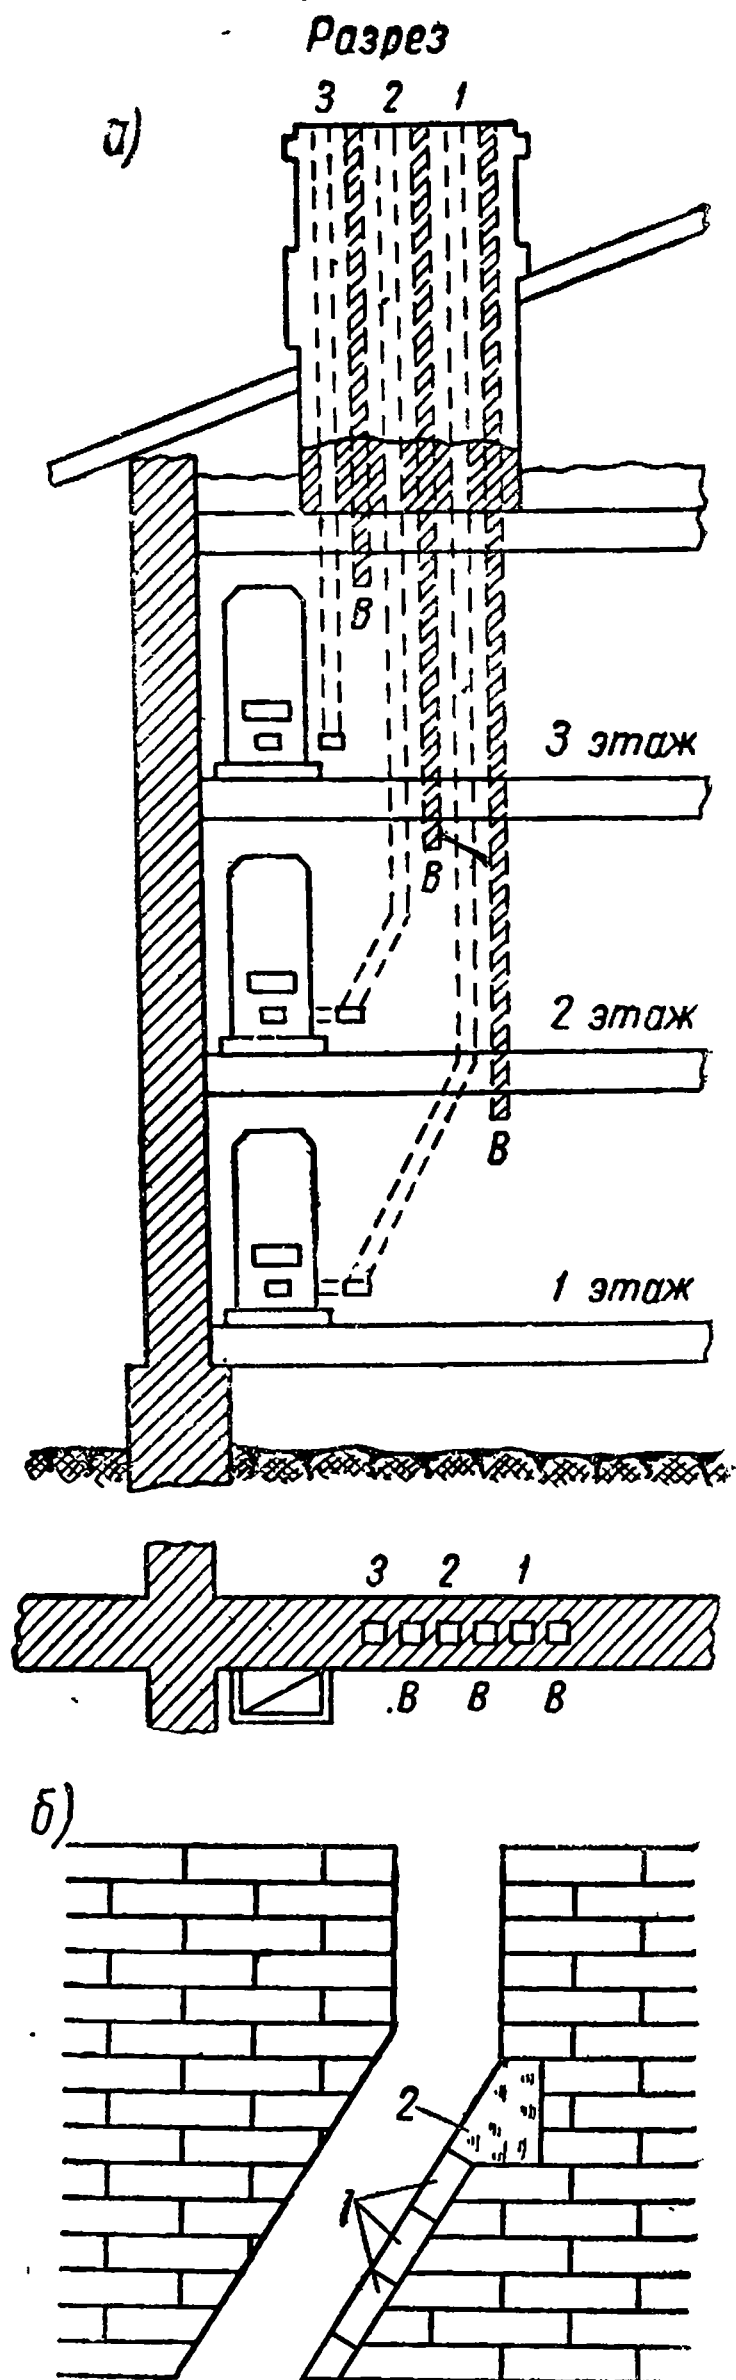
Расположение дымовых каналов в стенах здания: а — расположение дымовых и вентиляционных каналов в трехэтажном здании: 1, 2, 3 — дымовые каналы от печей 1-го, 2-го и 3-го этажей; В — вентиляционные каналы от 1-го, 2-го и 3-го этажей; б — кладка увода: 1 — кирпич плашмя; 2 — естественный камень.
